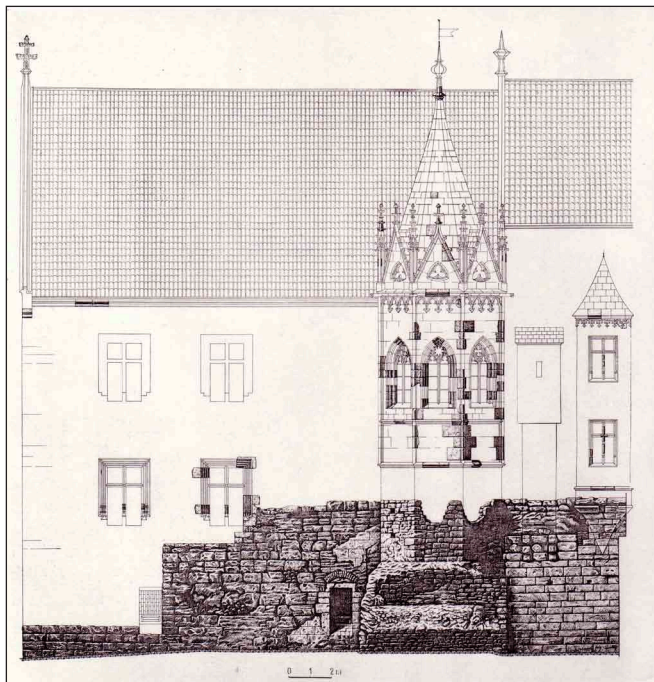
Buda, Königspalast. Detail der Ostfassade: Südbau mit Erker. Rekonstruktion mit Markierung der freigelegten Teile (nach Gerevich 1966).
